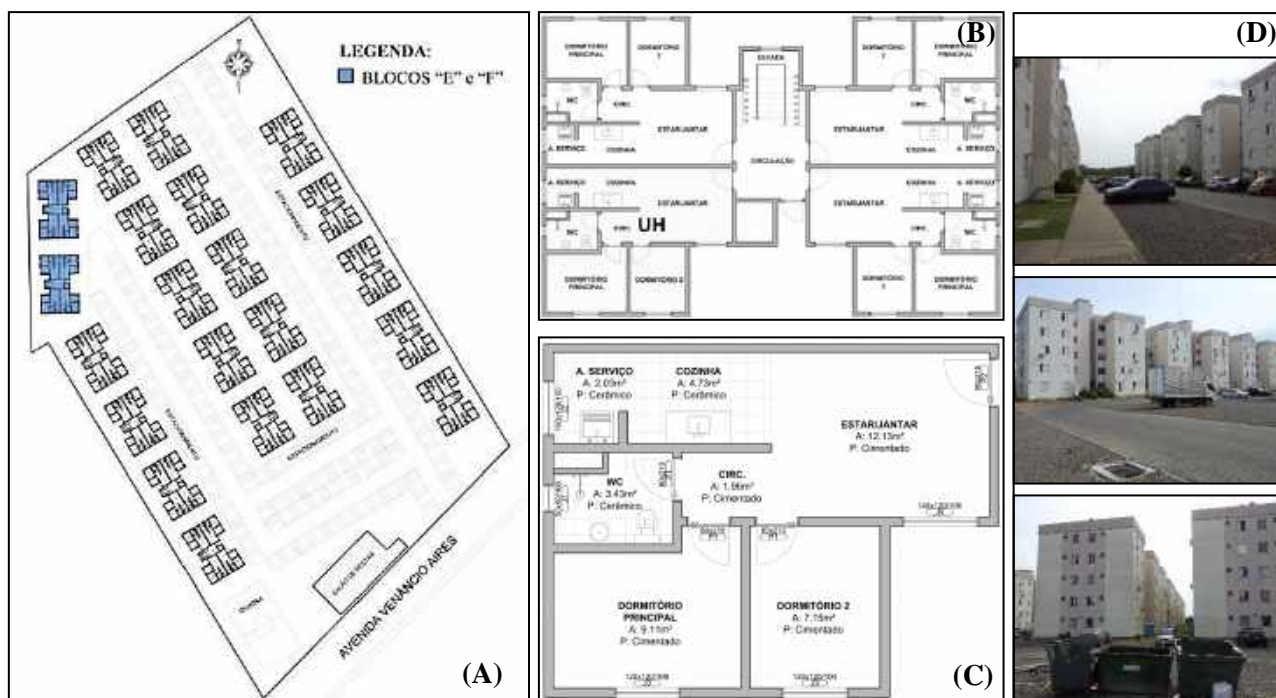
Plantas e imagens do CRV: (A) Implantação do CRV; (B) Planta dos pavimentos tipo; (C) Solução adotada para as UH do CRV; (D) Imagens do CRV.
